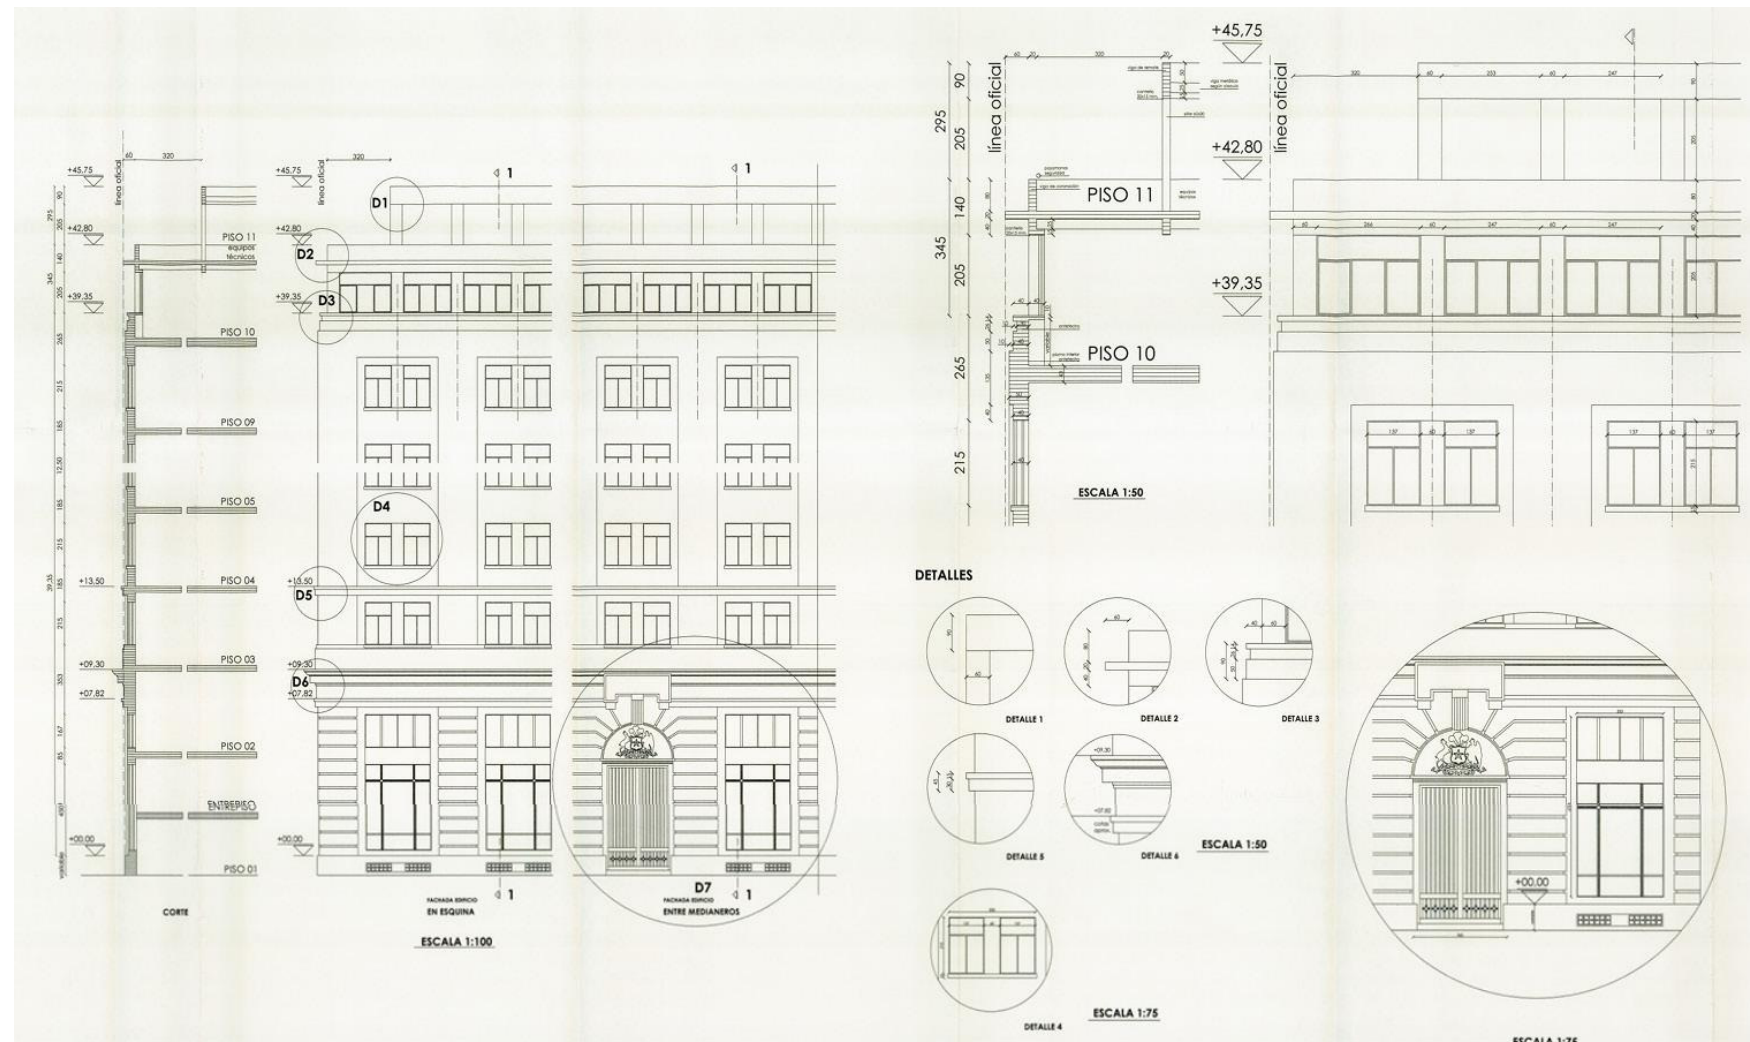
Plano Seccional “Barrio Cívico – Eje Bulnes” - Fuente: Municipalidad de Santiago
